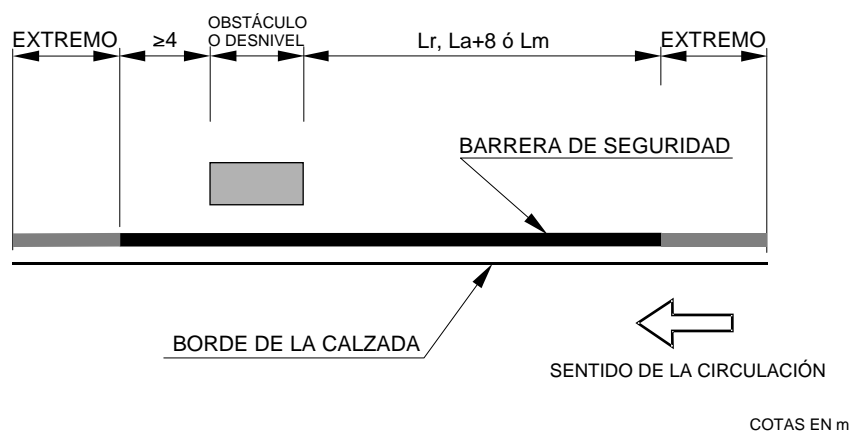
PROLONGACIÓN DE LA TERMINACIÓN EN LAS CARRETERAS CON CALZADAS SEPARADAS
